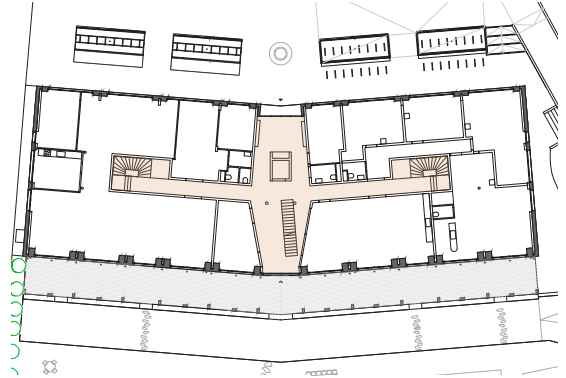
Plan du rez-de-chaussé, ©atba architectes.
